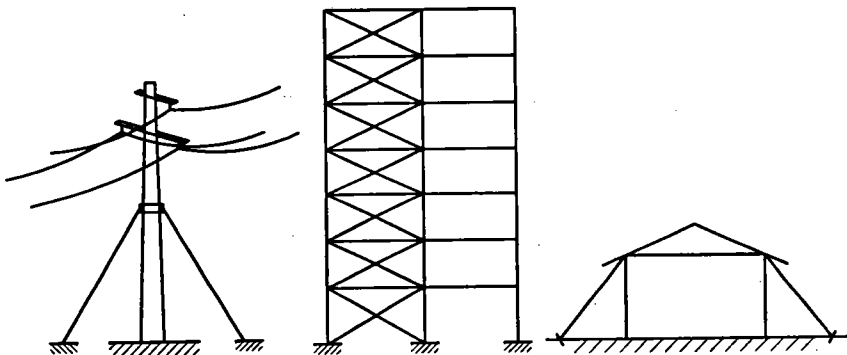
Các dạng giằng chéo để tăng độ cứng
